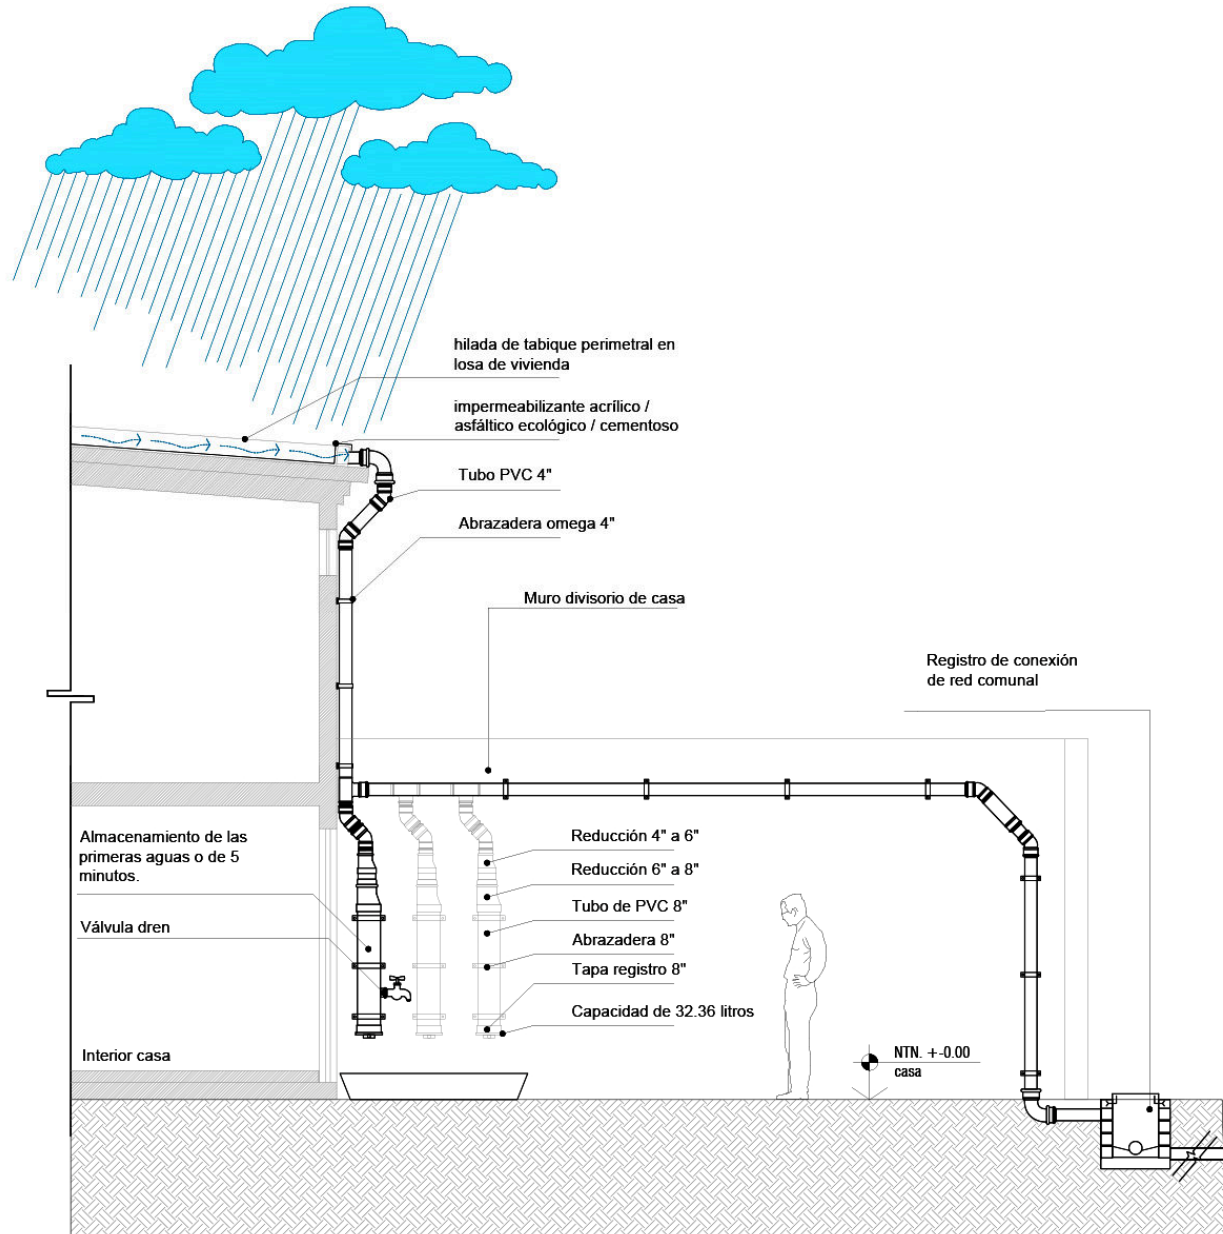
Instalación De Sistema De Captación Pluvial En Casa Tipo. Fuente: creación propia
